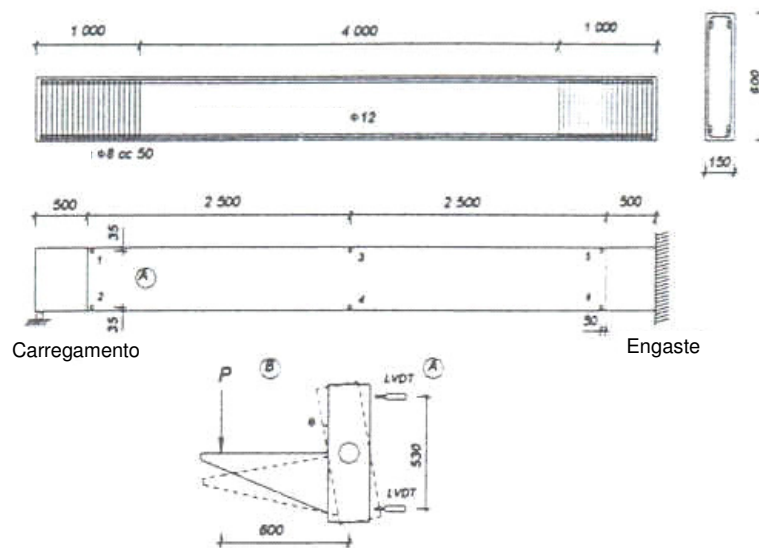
Detalhamento das vigas ensaiadas por Täljsten (2003).
